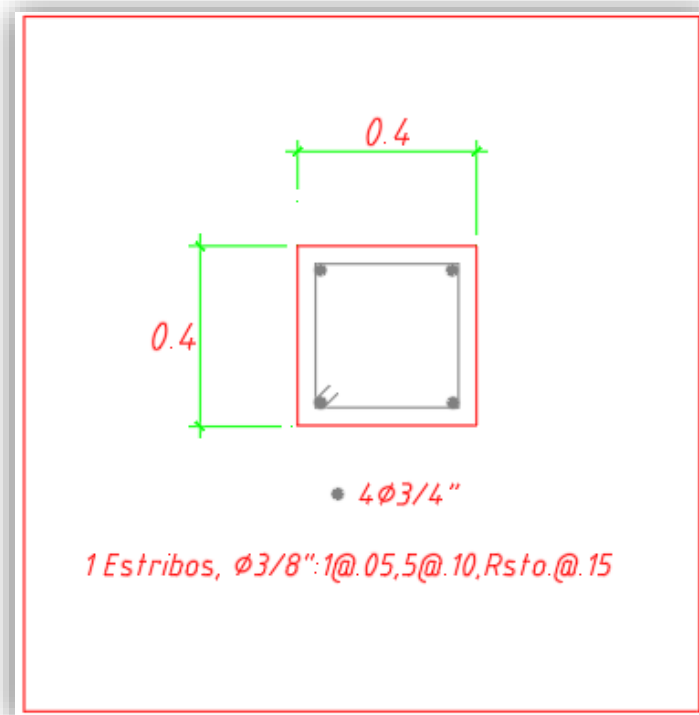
Detalle de refuerzo en columna C1 y C2 piso 6 y 7
